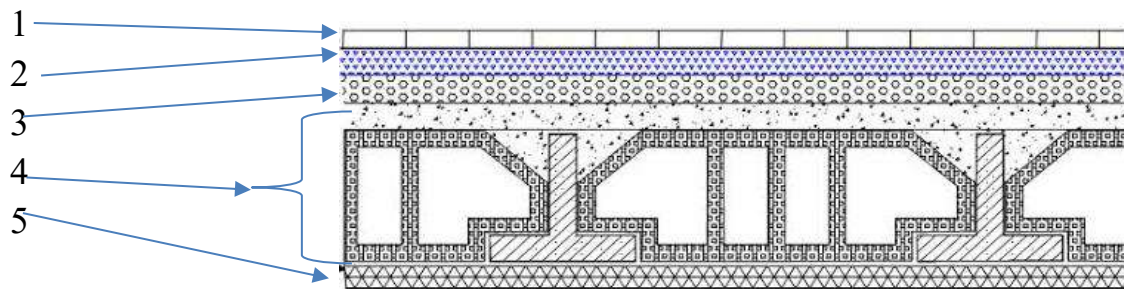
coupe d'un plancher RDC et étage courant à corps creux
